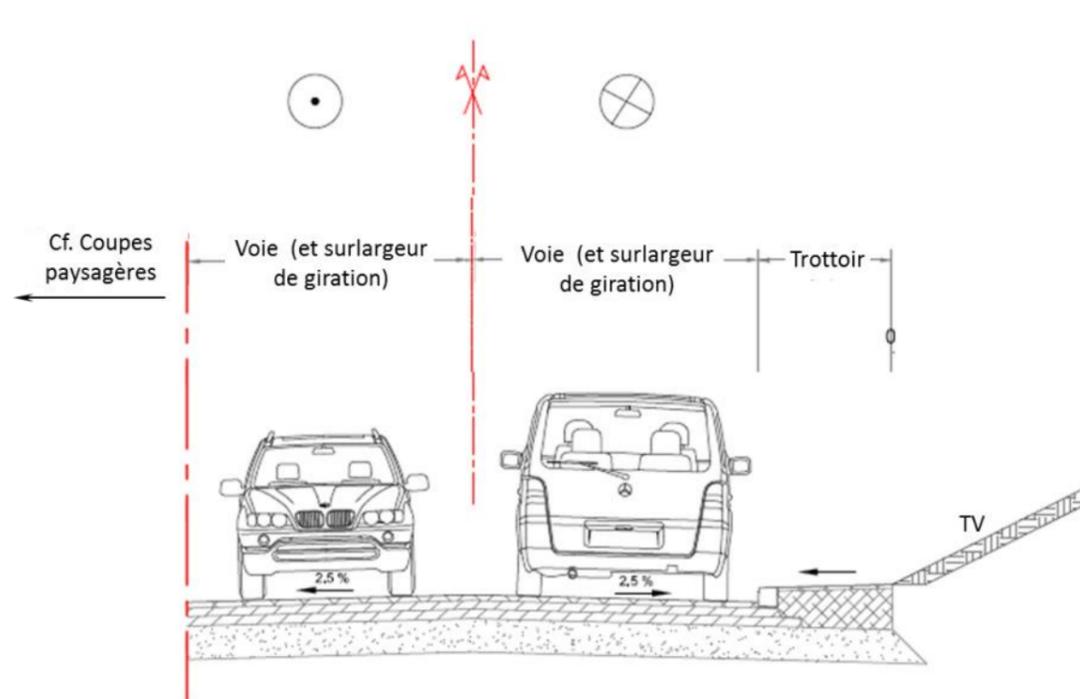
Profil en travers type mis en œuvre sur la route de Versailles (RD 446)
